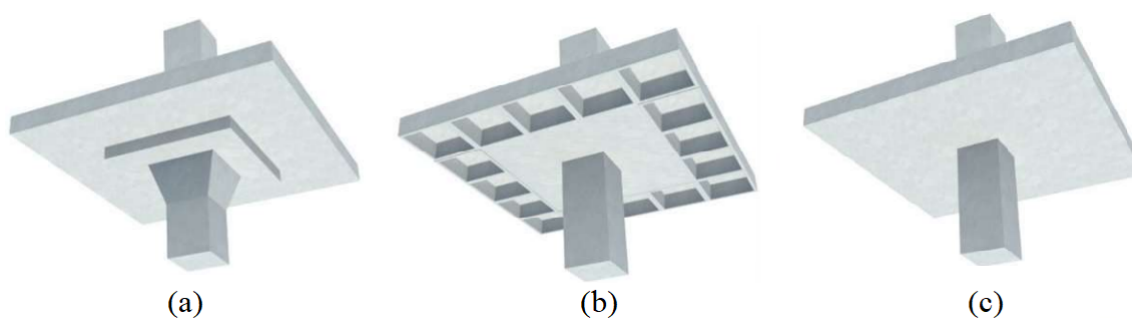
Lajes (a) cogumelo, (b) nervuradas e (c) lisas (fonte: Nicácio (2018))
